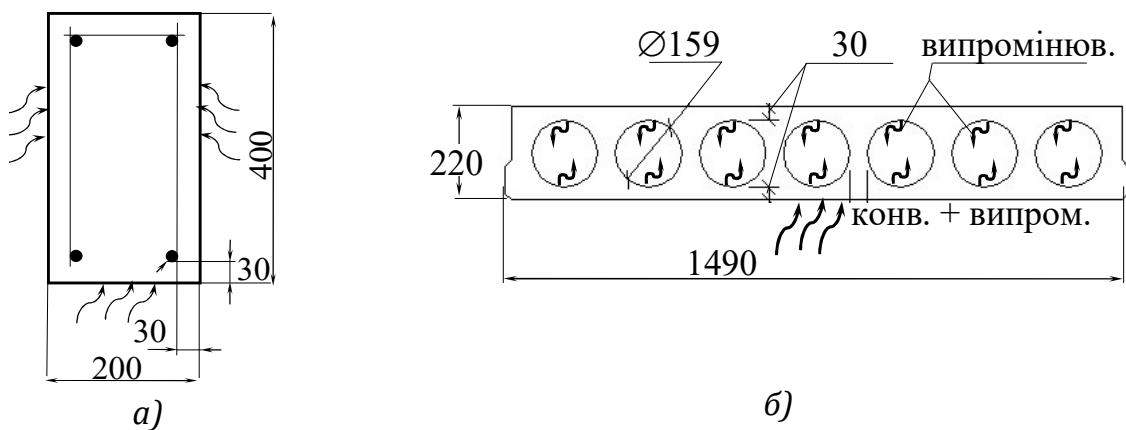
Розрахункові схеми перетинів залізобетонних конструкцій: а – залізобетонна балка, б – залізобетонна пустотна плита
